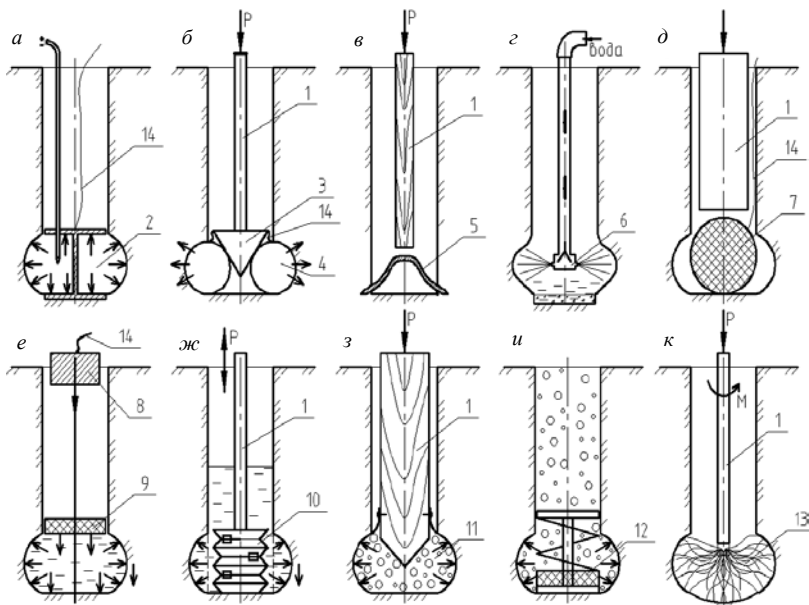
Прогрессивные конструкции устройств и приспособлений для образования уширений в забое скважин: 1 – шток; 2 – разрядное устройство с проводами; 3 – конус; 4 – шары (два или три); 5 – изогнутая заостренная пластина; 6 – размывное устройство (монитор); 7 – упругий резиновый шар; 8 – ударный груз; 9 – поплавок; 10 – вантуз с отверстиями; 11 – мешок со щебнем или галькой; 12 – заряд взрывчатого вещества; 13 – абразивный проволочный материал; 14 – гибкая тяга
